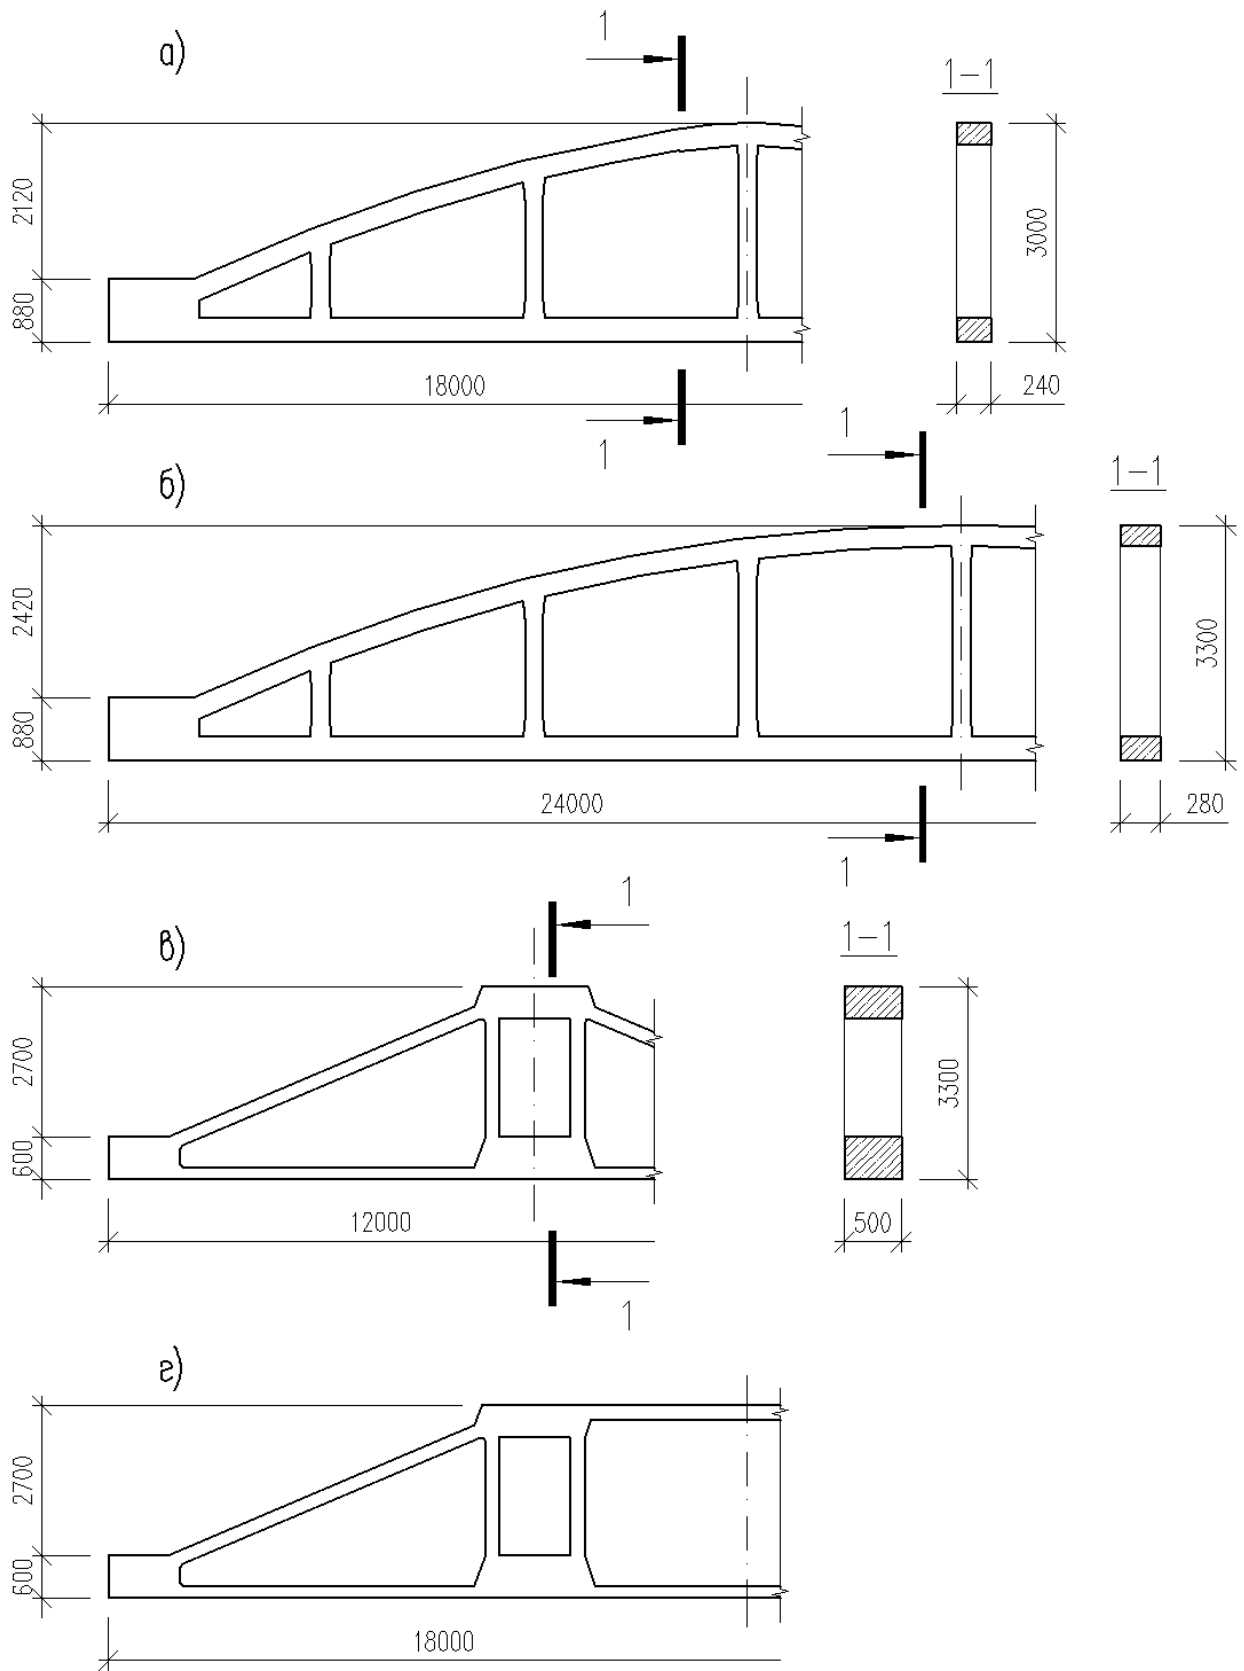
Стропильные и подстропильные железобетонные фермы:
